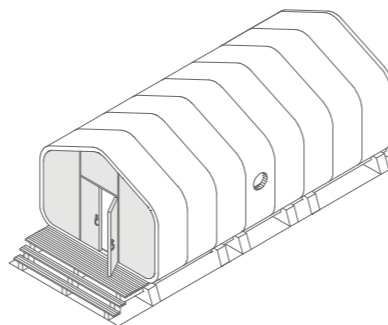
Axonometría Wikkelhouse. Fuente: Autores, 2023
